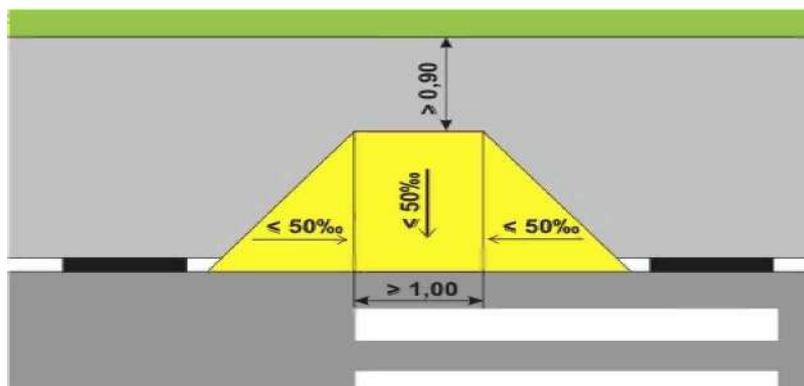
Вариант размещения пандусов на отнесенных пешеходных переходах и пешеходных переходах, располагаемых на перегонах
